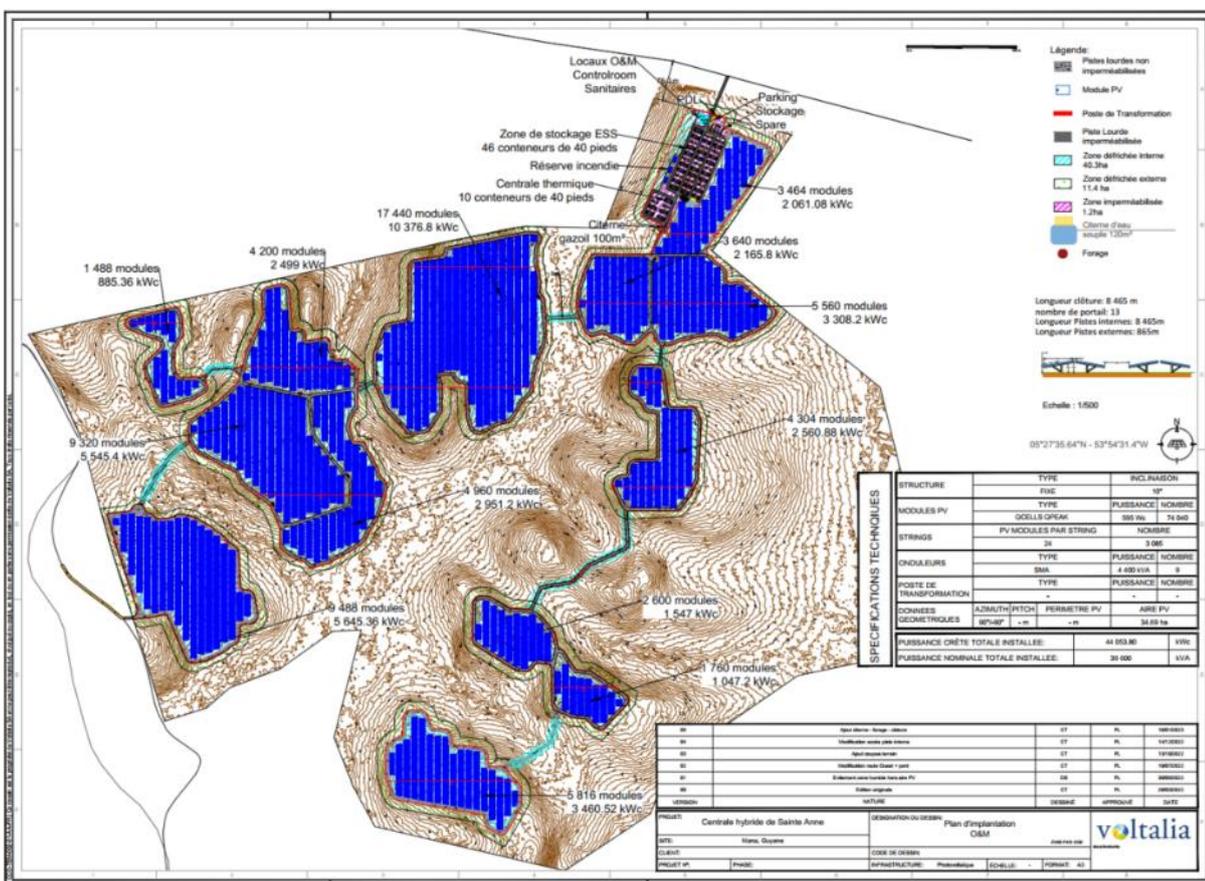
Plan d'implantation de la variante n°5, retenue à ce jour
